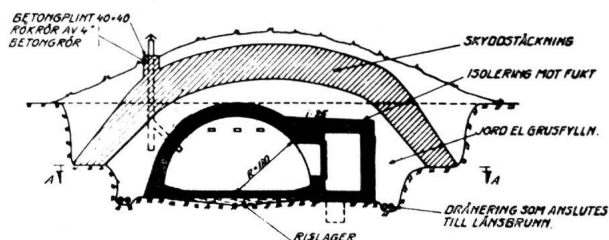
Aufriss B-B. betongplint = Betonsockel 40×40, rökrör = Rauchabzug aus 4"-Betonrohr, skyddstäckning = Schutzbedeckung, isolering mot fukt = Isolierung gegen Feuchtigkeit, jord eller grusfyllning = Erde oder Schotterfüllung, dränering som anslutes till länsbrunn = Entwässerung, an Entleerungsschacht angeschlossen, rislager = Reisiglager.
